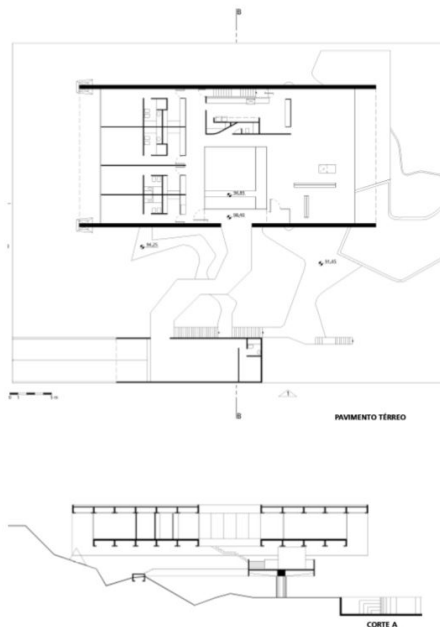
planta baixa e corte longitudinal, casa Helena Ometto, Paulo Mendes da Rocha
